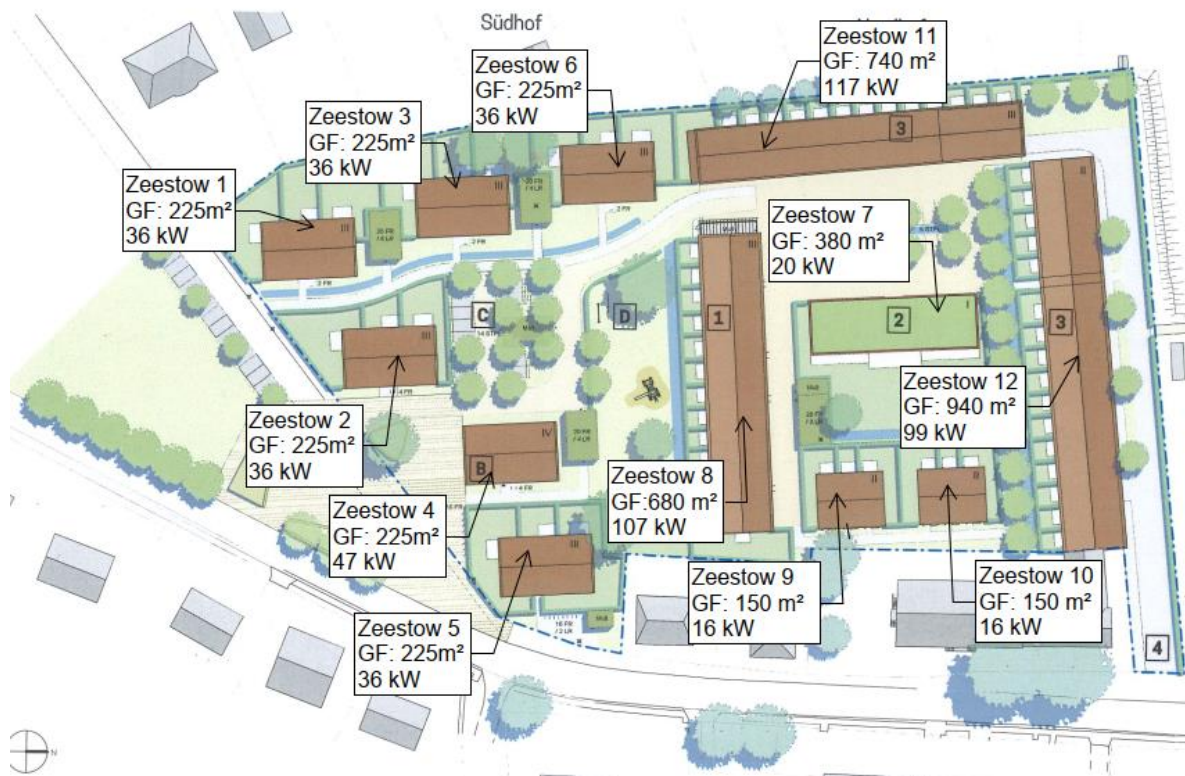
Lageplan mit Anschlussbeschriftung - Erweiterung Zeestow Rittergut
